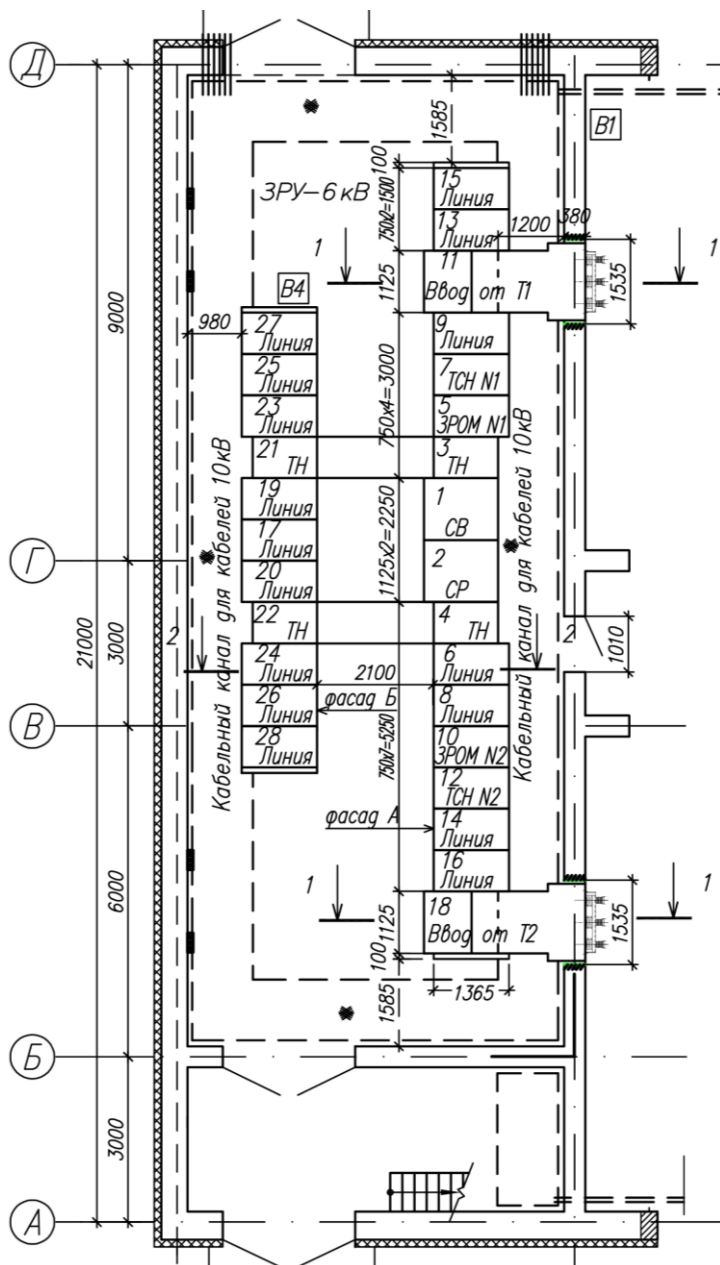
План размещения шкафов К-61 на отм.+0,000
